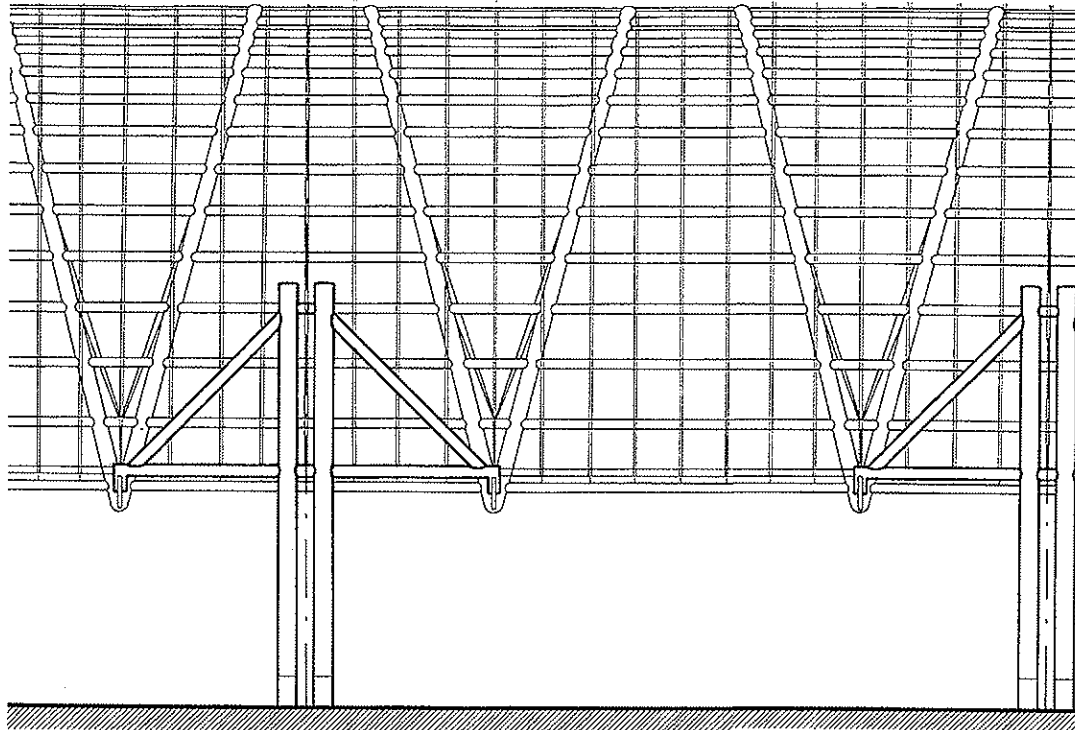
Coupe longitudinale partielle de la halle et détail d'un vitrage
